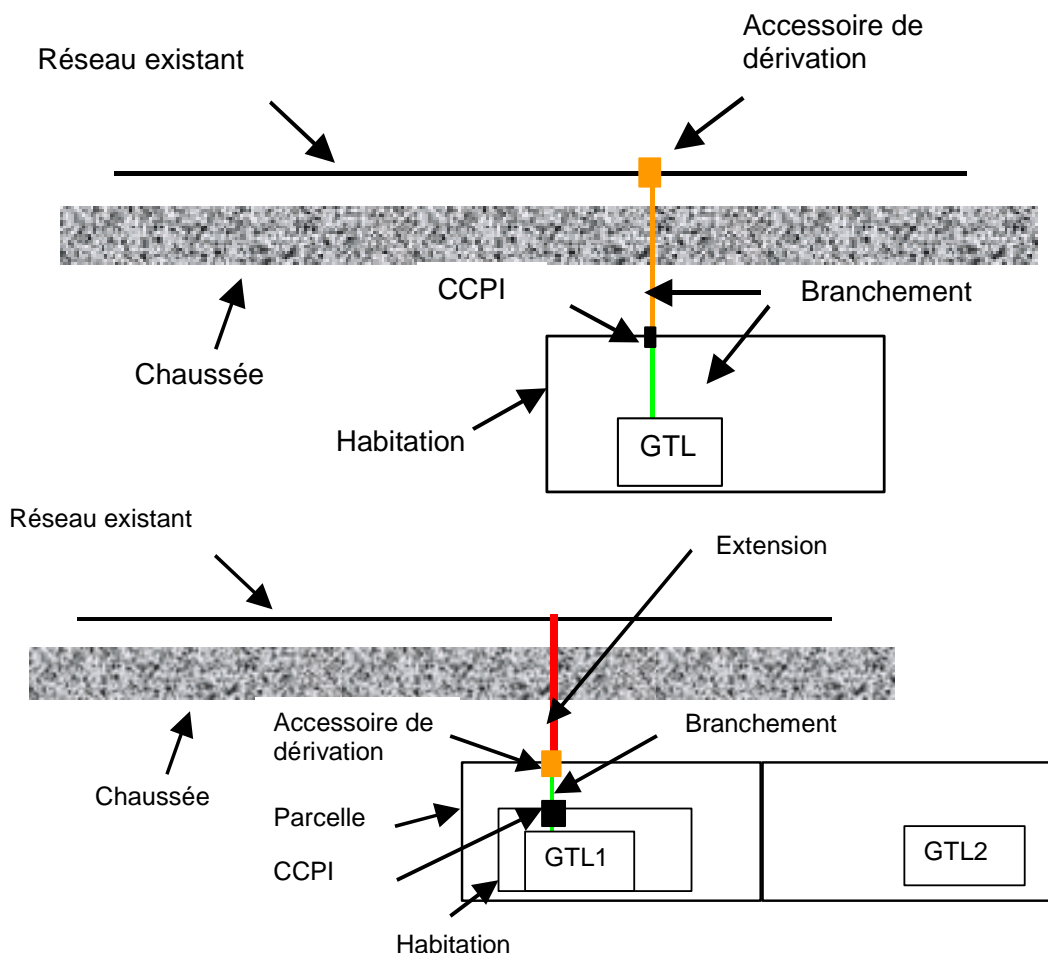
Raccordement individuel BT \leq 36 kVA avec traversée de chaussée
